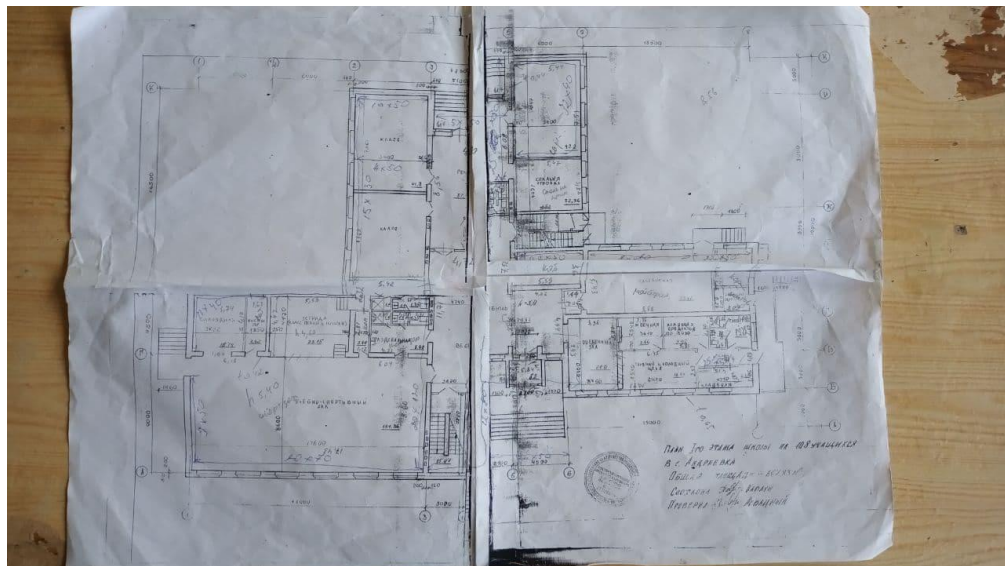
План будівлі 1-го поверху Андріївського ліцею.
